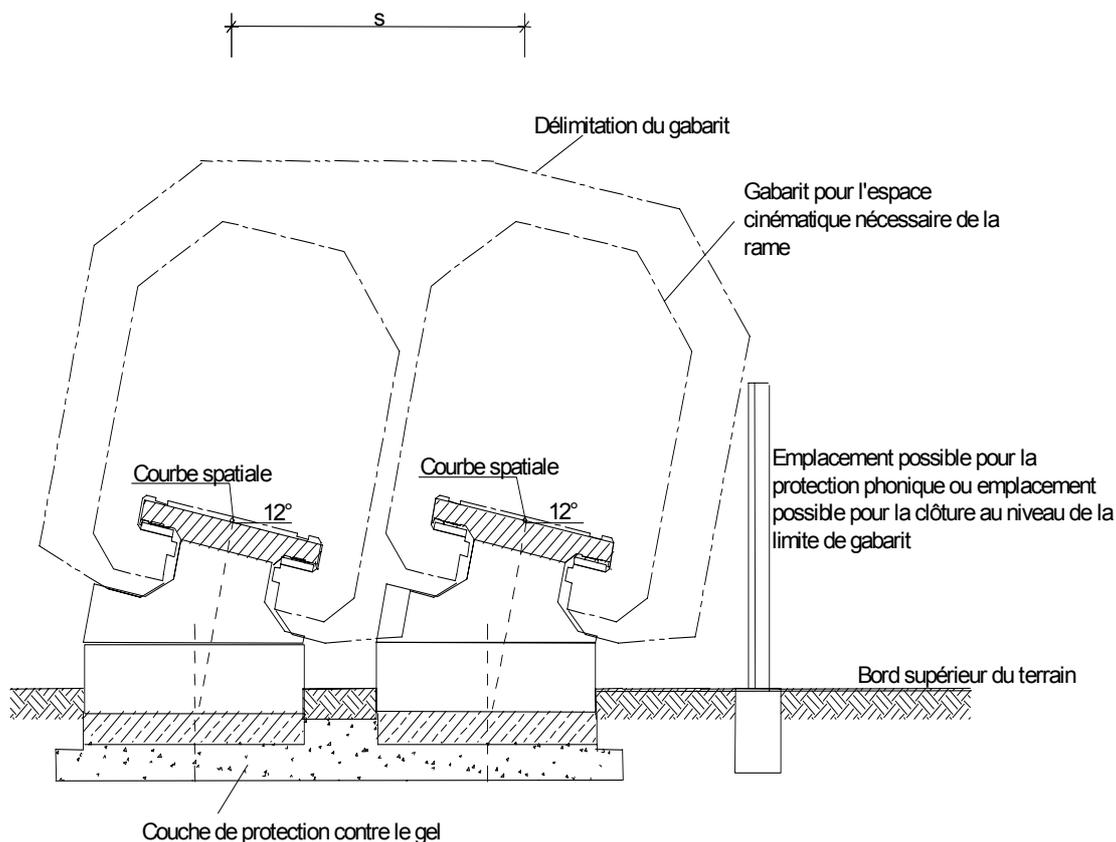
Mur d'isolation phonique et clôture de protection sur une voie de niveau (exemple)
